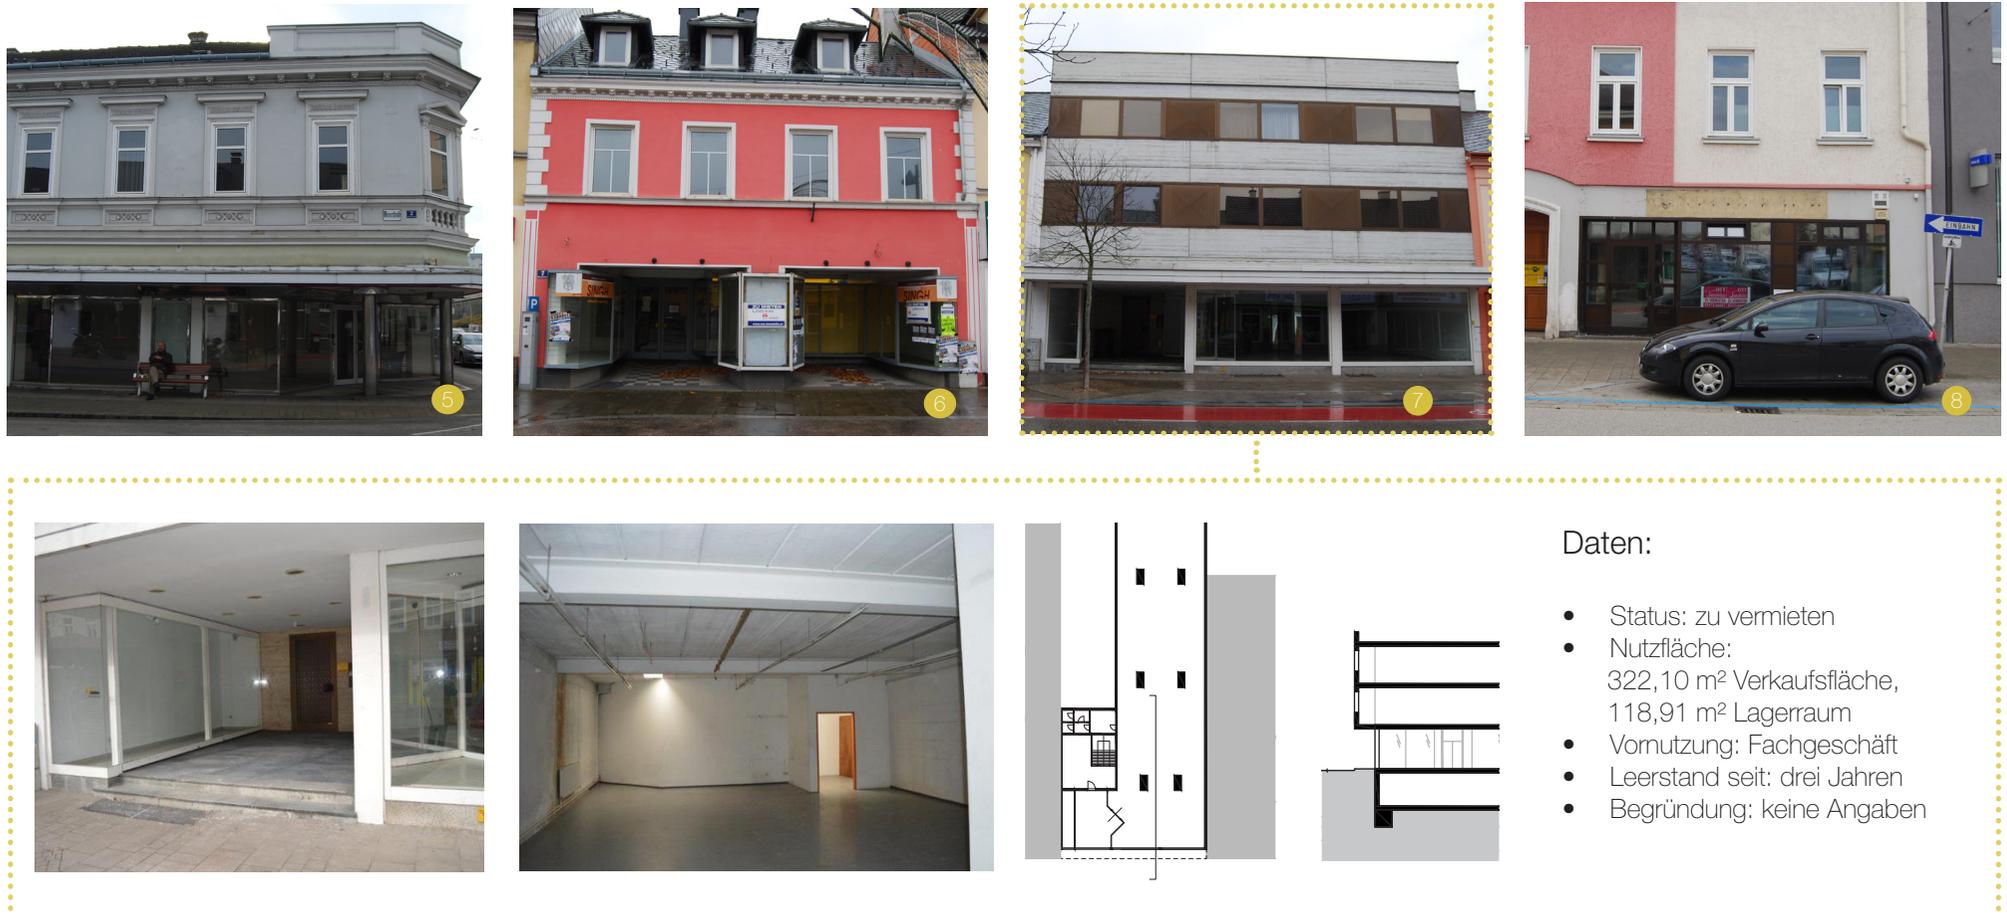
Leerstand in der Wienerstraße 11: Fotos, Grundriss, Schnitt, Informationen
